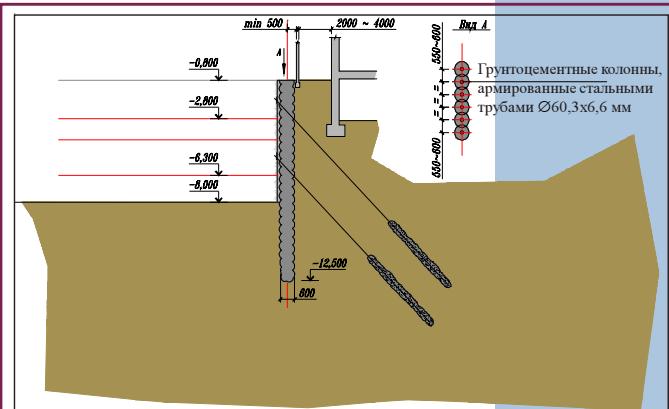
Ограждение котлована из секущихся грунтоцементных свай-колонн на строительстве нулевого цикла нового офисного здания на Via Valenza в Милане. Принципиальное решение.
